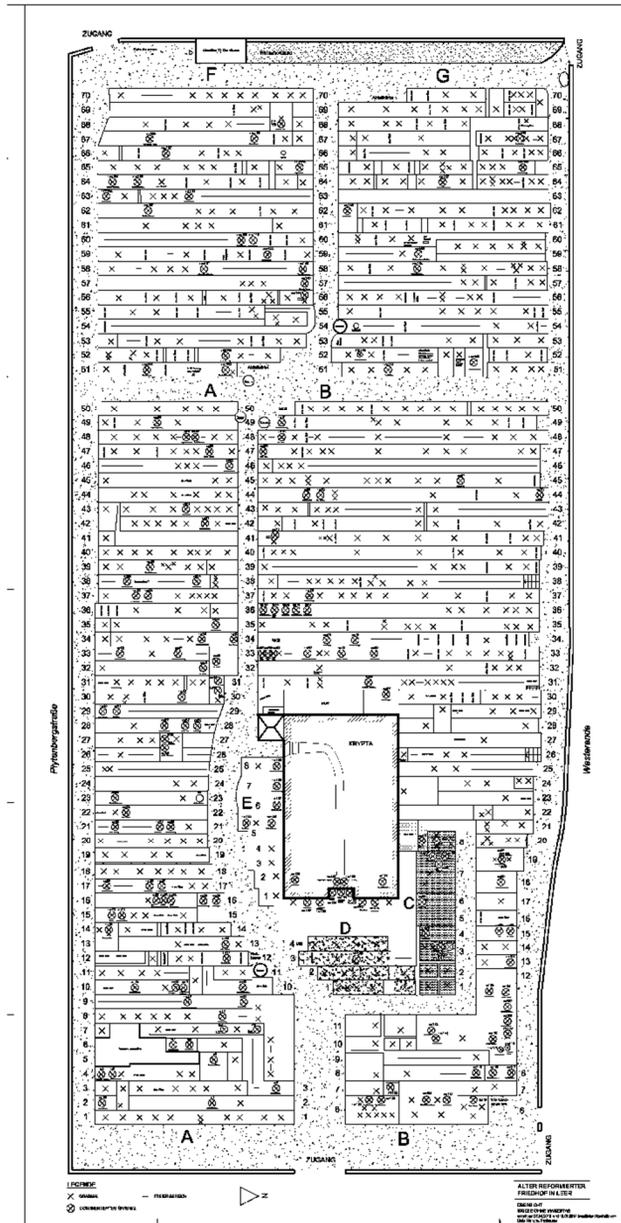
Lageplan des alten reformierten Friedhofs 2014
